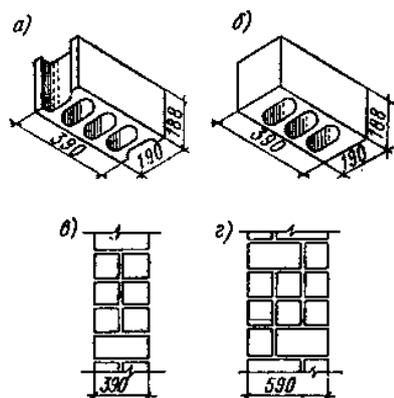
Стены из легкобетонных трехпустотных камней: а – ложковый камень; б – тычковый камень; в – стена в одинок камень; г – стена в полтора камня
